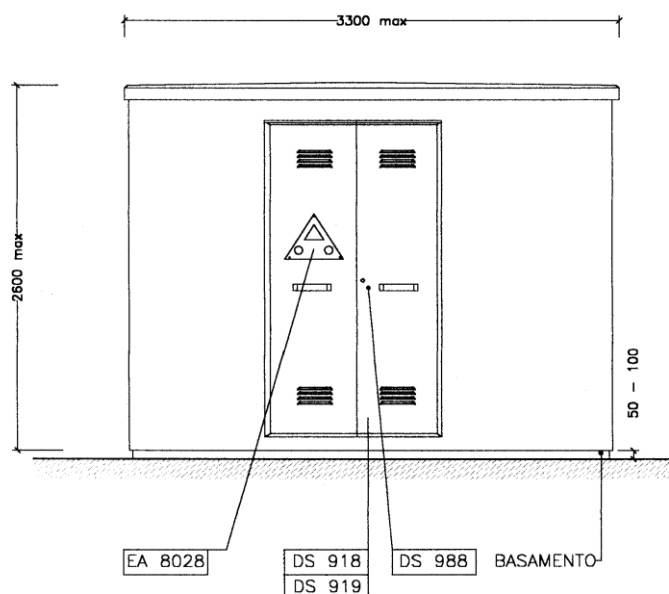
Layout cabina E-Distribuzione – vista frontale
